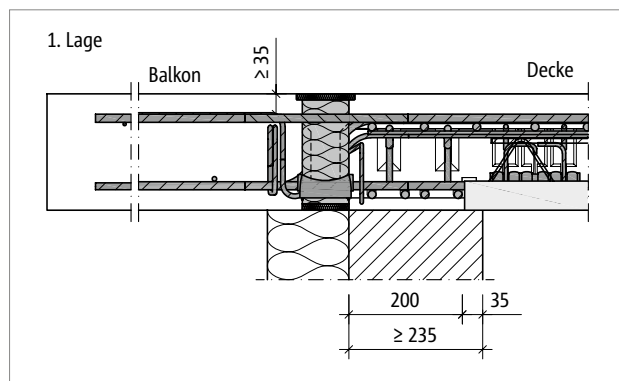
Schöck Isokorb® T Typ C: Halbfertigteilplatte ohne Randunterstützung mit WDV (Schnitt T Typ C-CV35-1. Lage, Ansicht T Typ C-CV50-2. Lage)
